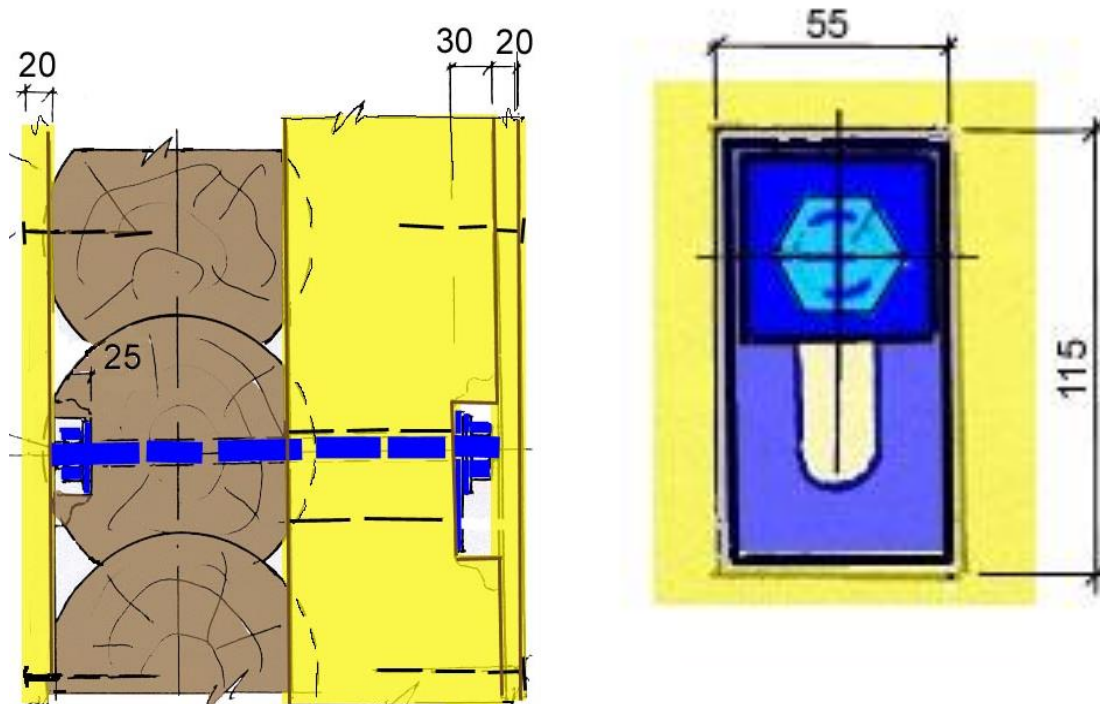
Усиление бревенчатых стен вертикальными сжимами
